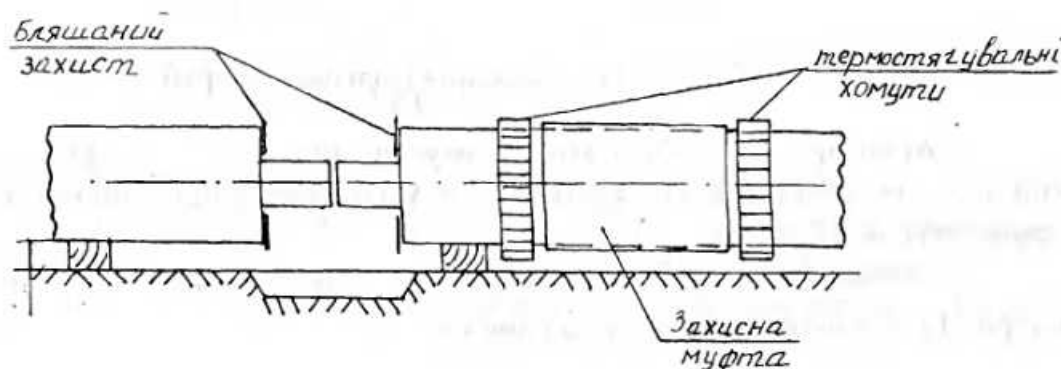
Схема з'єднання прямих труб перед зварюванням
